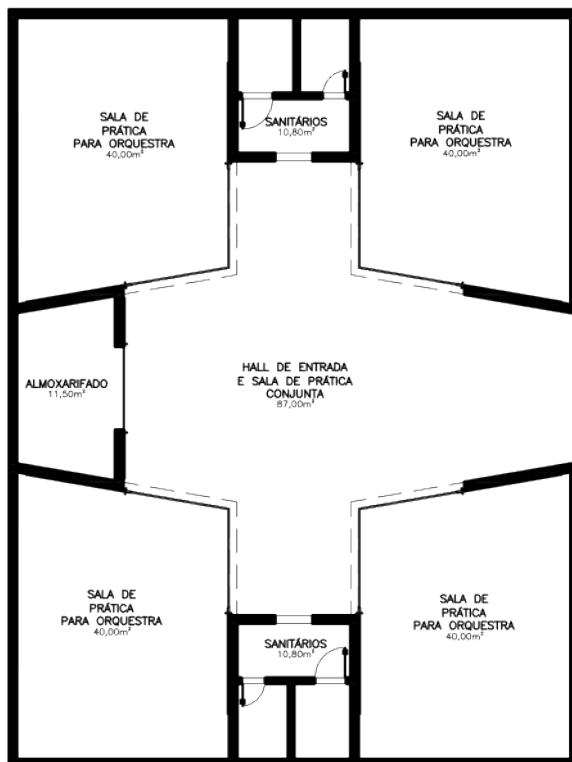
BLOCO ORQUESTRA - PLANTA - ESC.: 1:200
